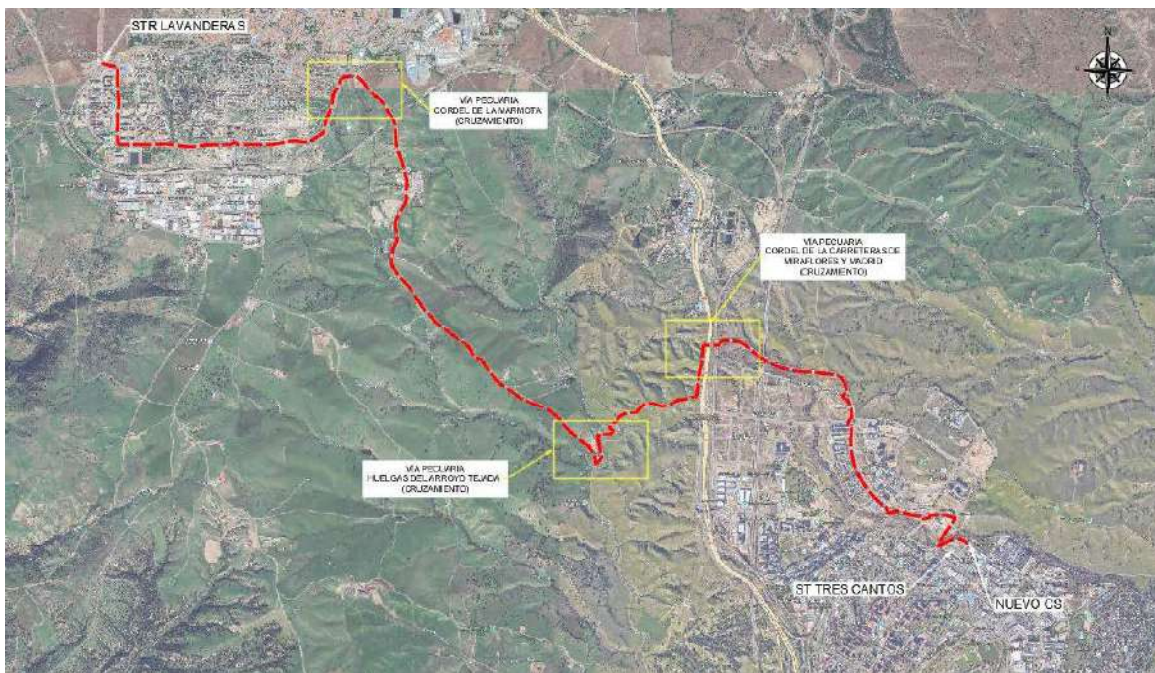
Plano trazado completo línea subterránea proyectada 20kV
